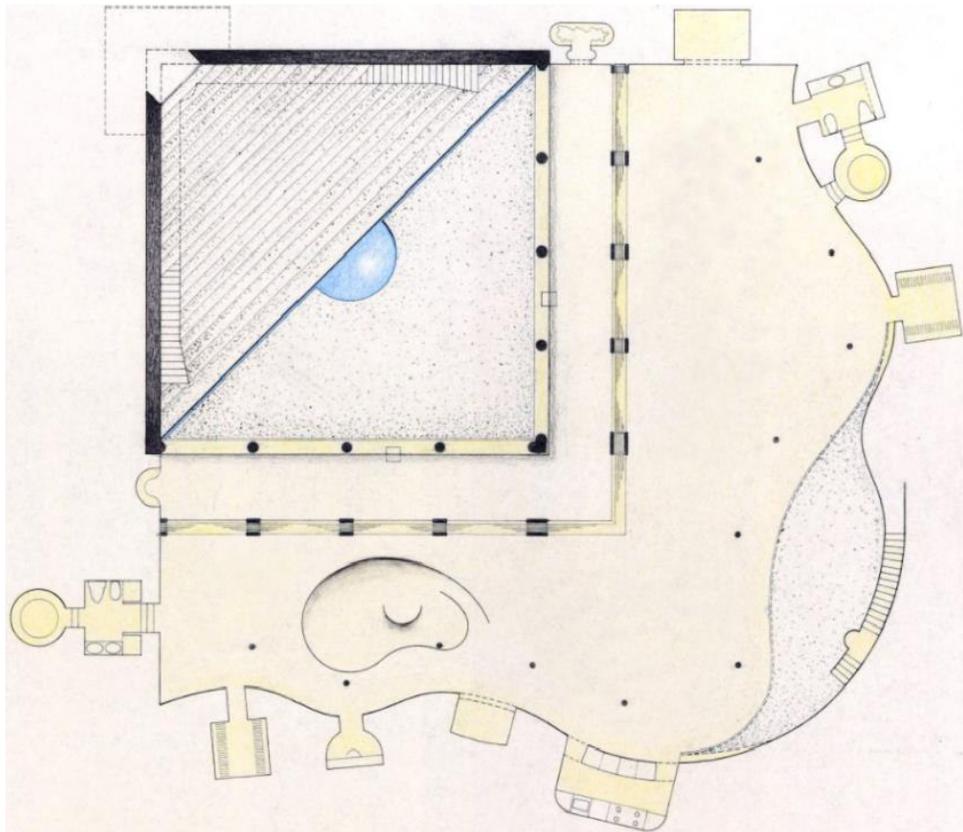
Boceto de planta arquitectónica. (Urbipedia, 2004)
